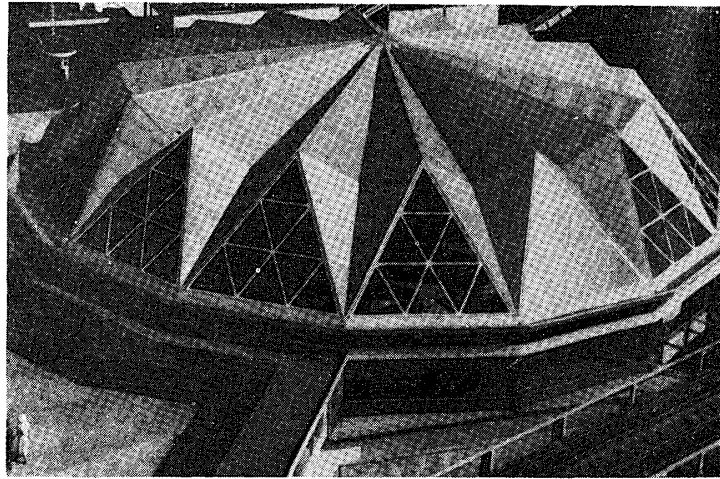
16個の folded plate よりなる shell construction, 直径約109呎 (Wood, 26, 484, (1961))
